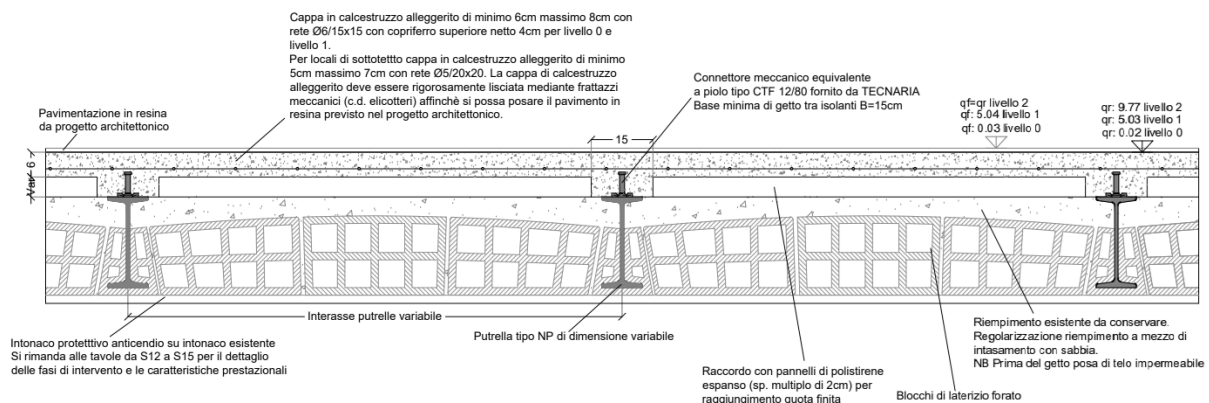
Intervento di consolidamento di un solaio in putrelle e blocchi di laterizio forato con cappa collaborante per il recupero dell'Ex Istituto Mondino di Pavia (lavori di Studio Calvi BEAM BEAM)
